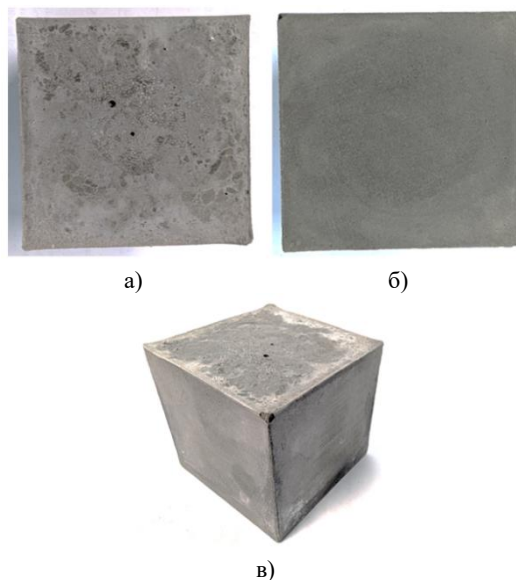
Внешний вид отвержденного образца ЦМ через 2 суток: а) верхняя поверхность; б) нижняя поверхность; в) внешний вид
